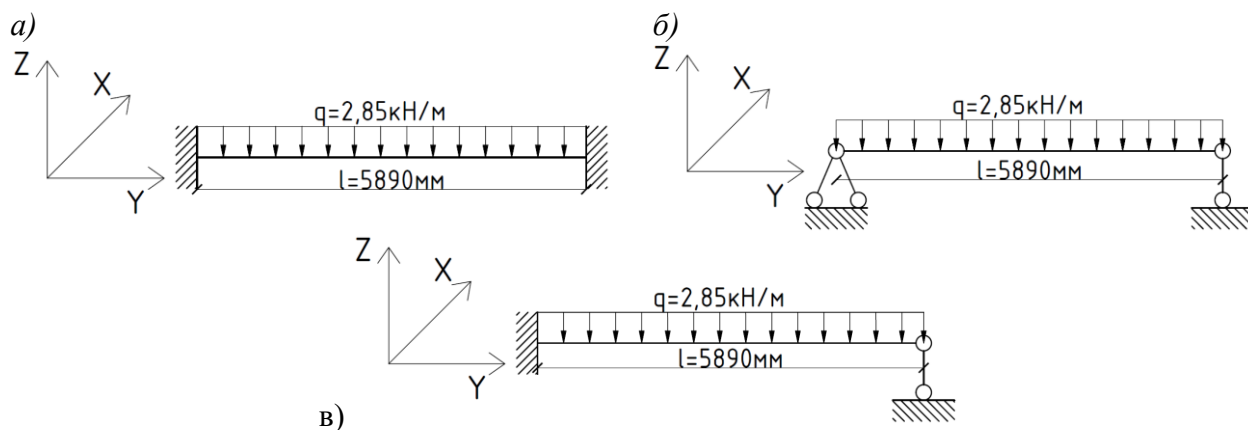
Расчетные схемы трехслойной плиты из ДПК с граничными условиями: а) жесткое защемление; б) шарнирное опирание; в) жесткое защемление с шарниром
